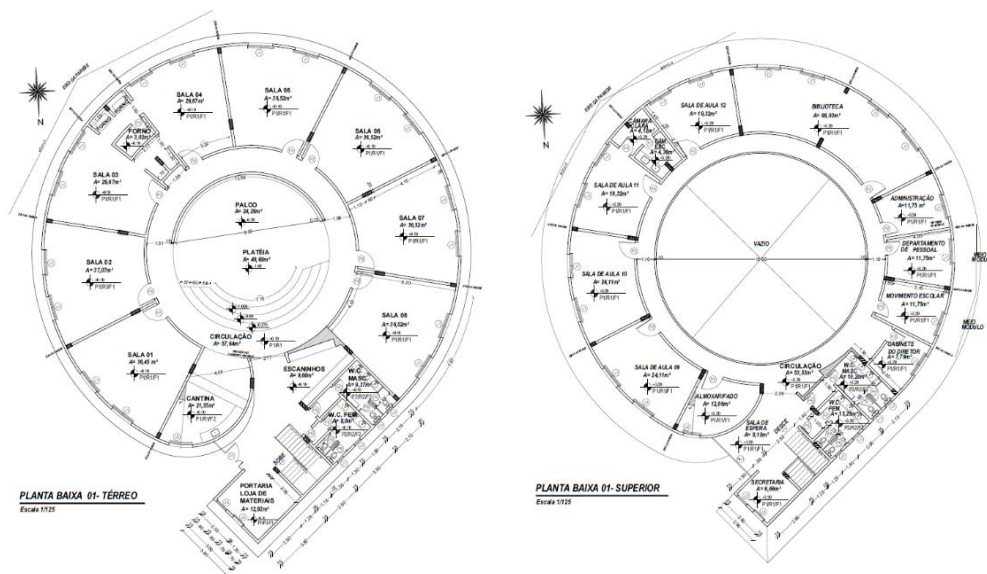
Plantas Baixas da Escola de Artes Cândido Portinari
